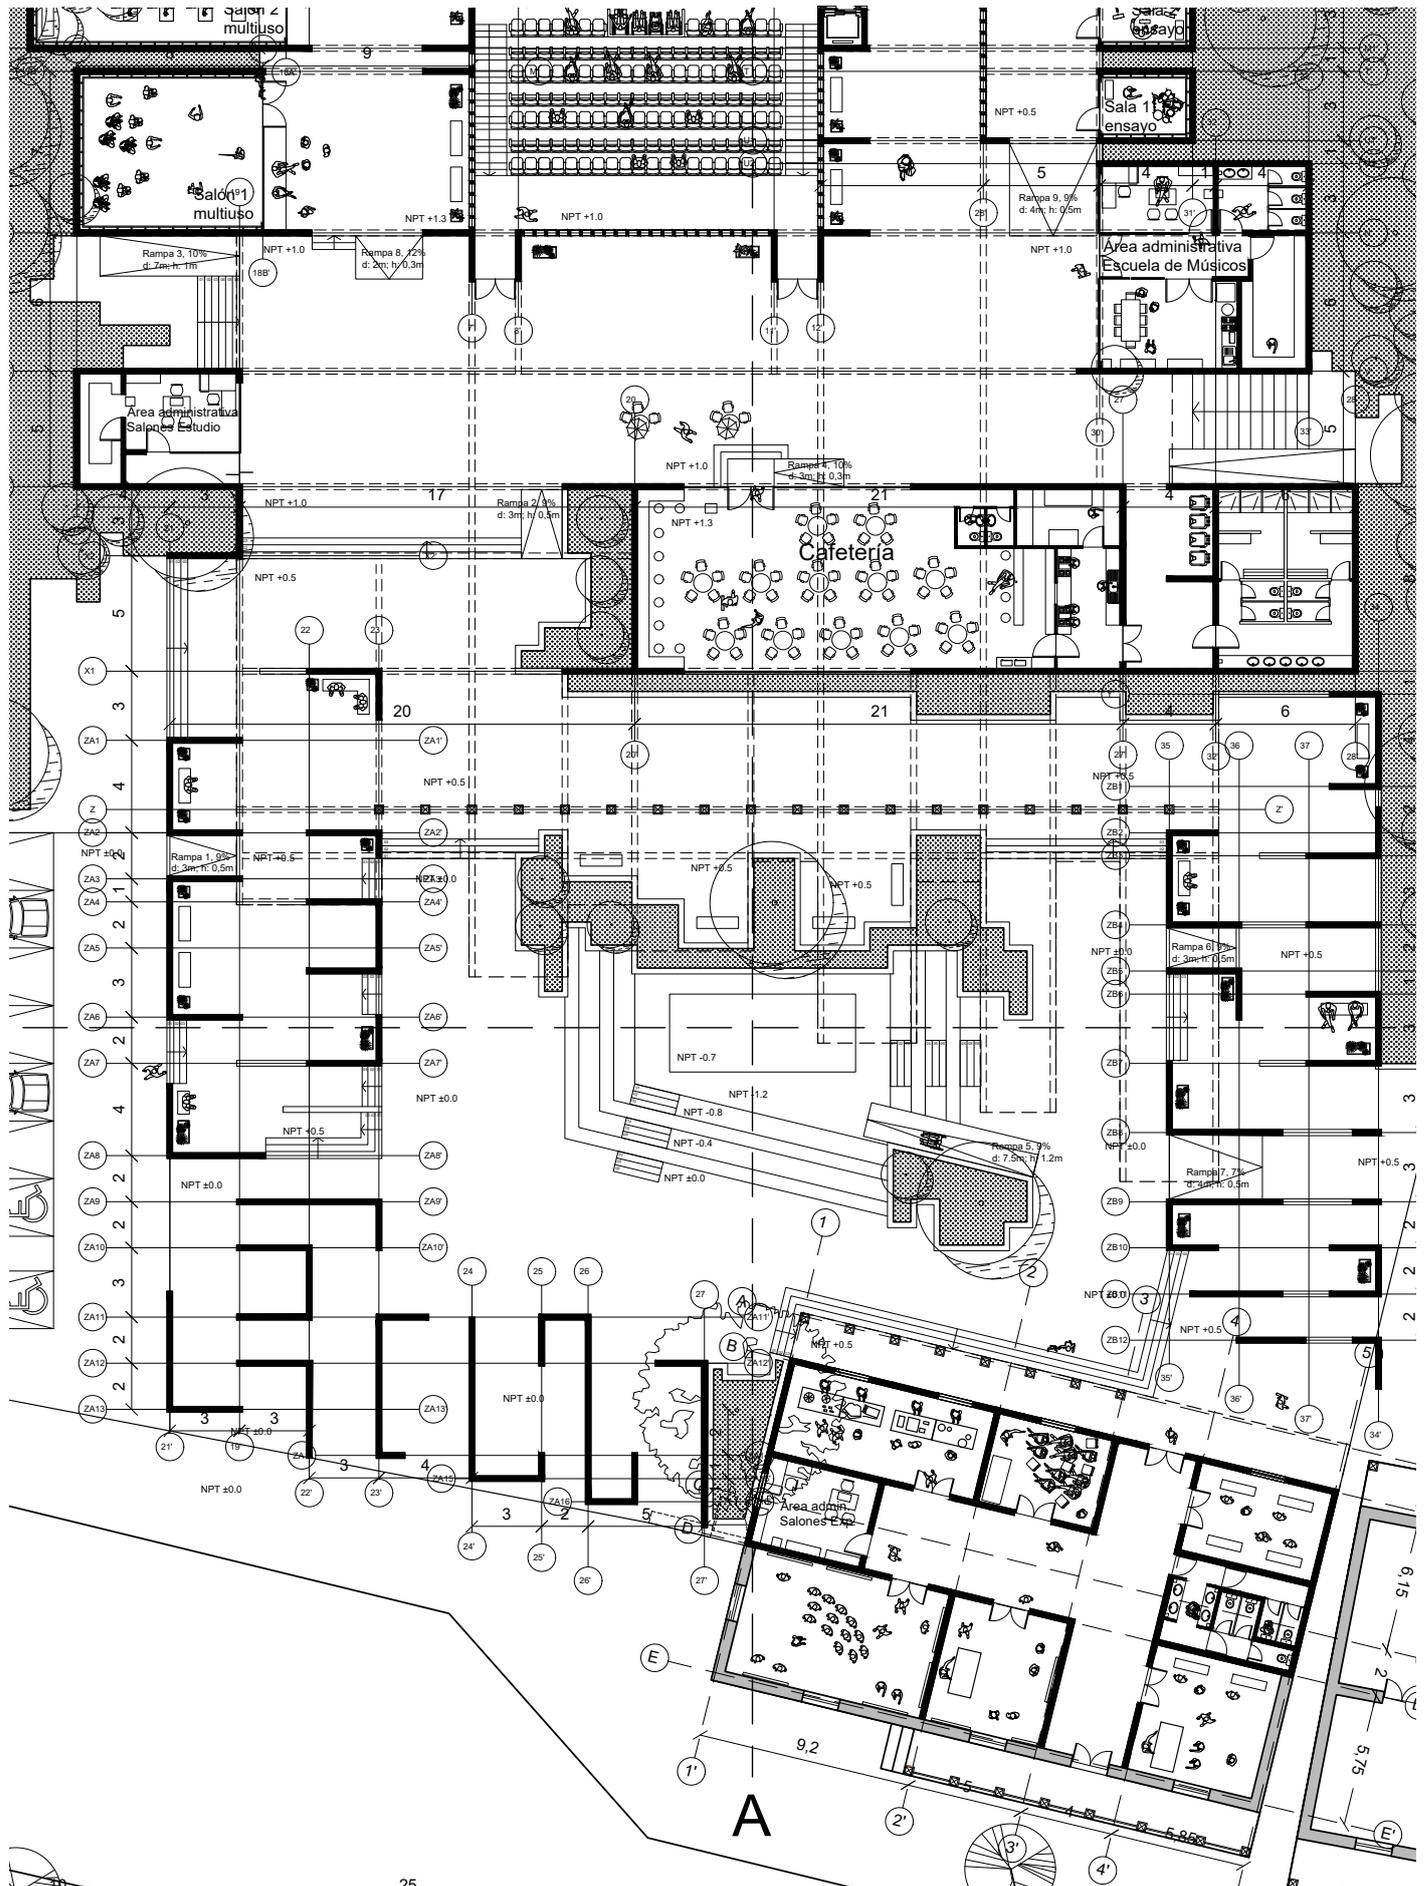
Planimetría, detalle de espacio público y plaza enterrada. (Elaboración propia)
